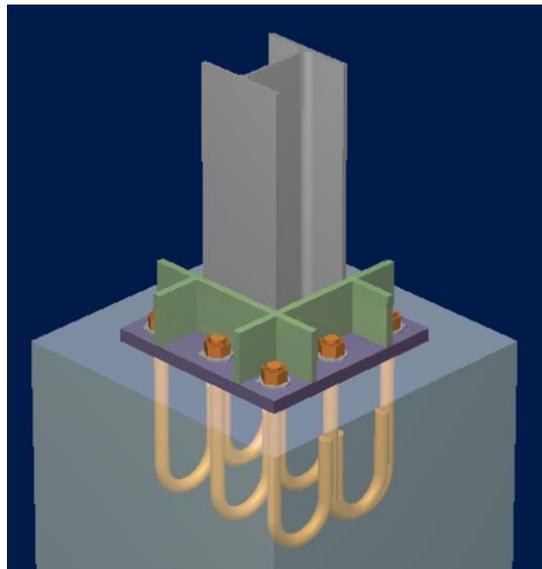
Placa Base con pernos de anclaje y dado de hormigón
